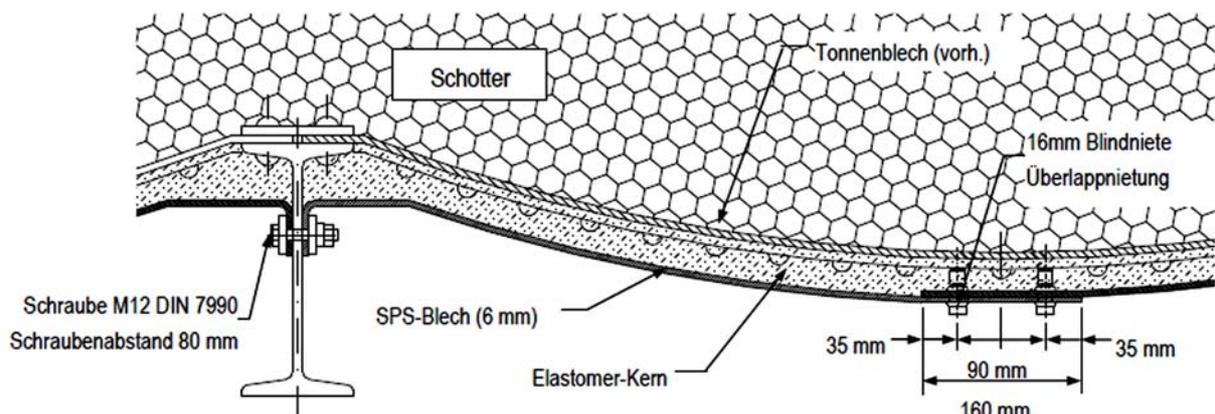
SPS – Sandwich-Querschnitt mit Verbindungsdetails
